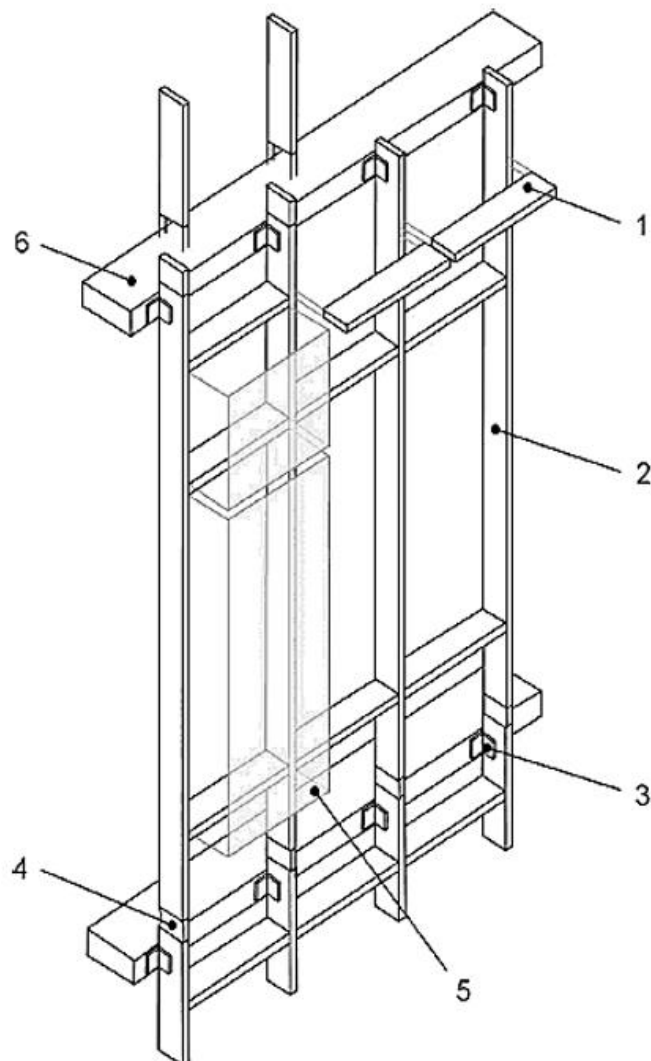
Стійково-ригельна конструкція фасадна навісна
